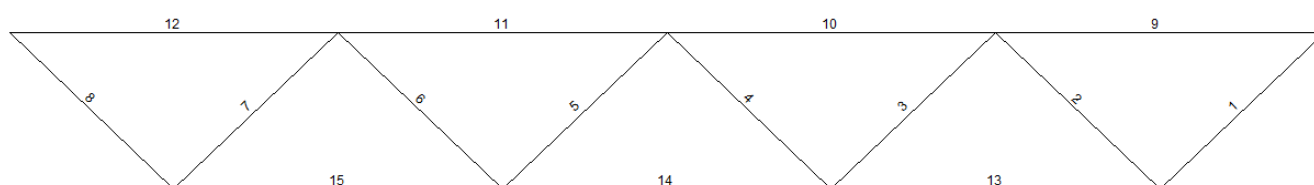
Нумерация строжней фермы ФП1.
